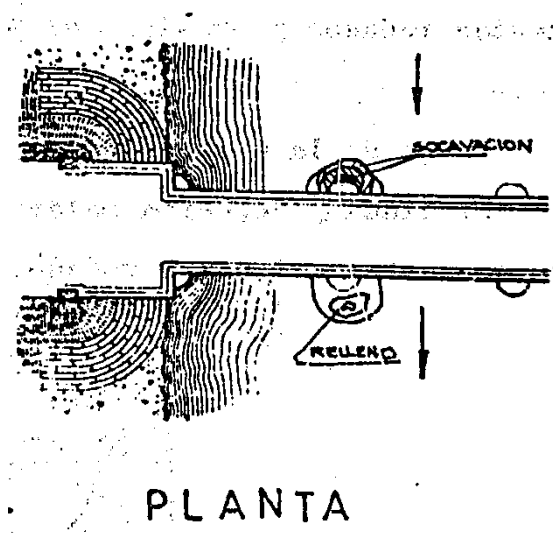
Esquema de erosión y socavación alrededor de una pila.
